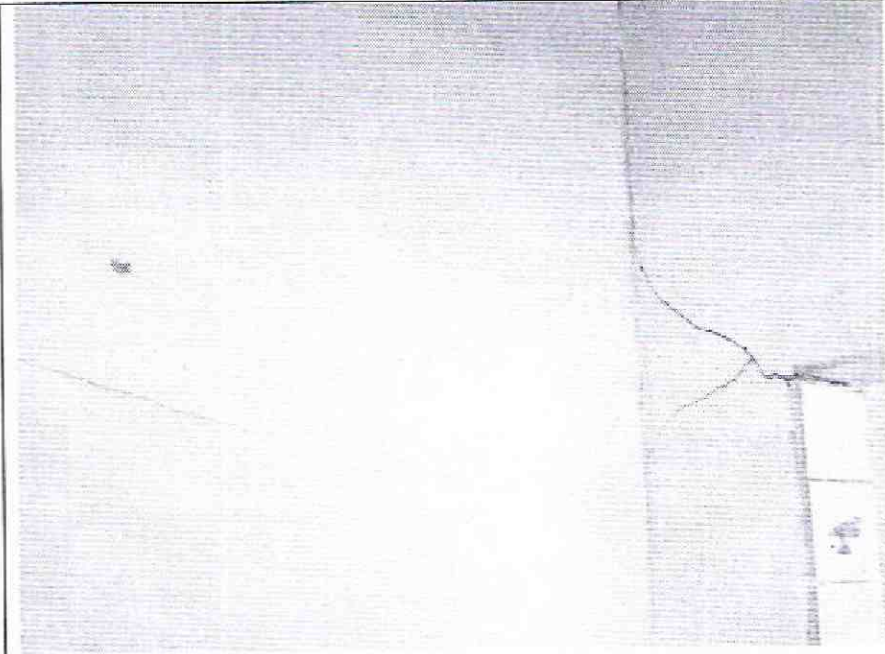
Grietas en muros de segundo piso, daño severo.
